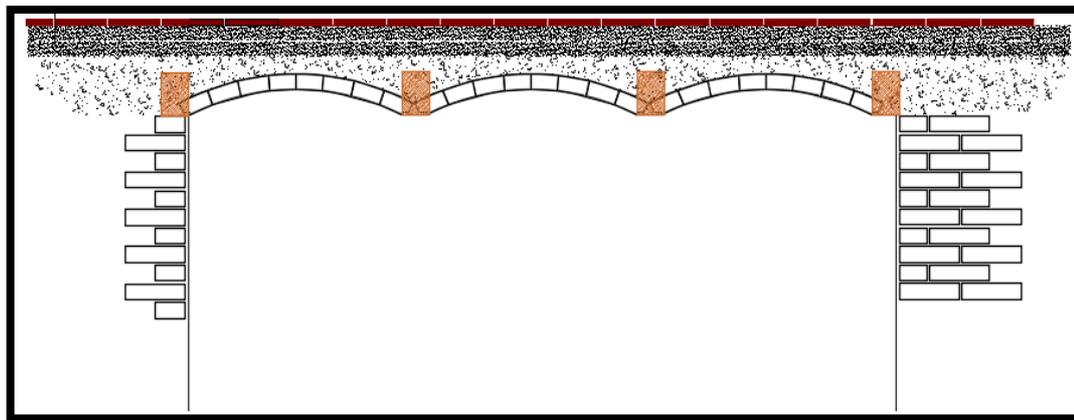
Coupe verticale d'une intervention sur un mur porteur. (Source : Auteur).
